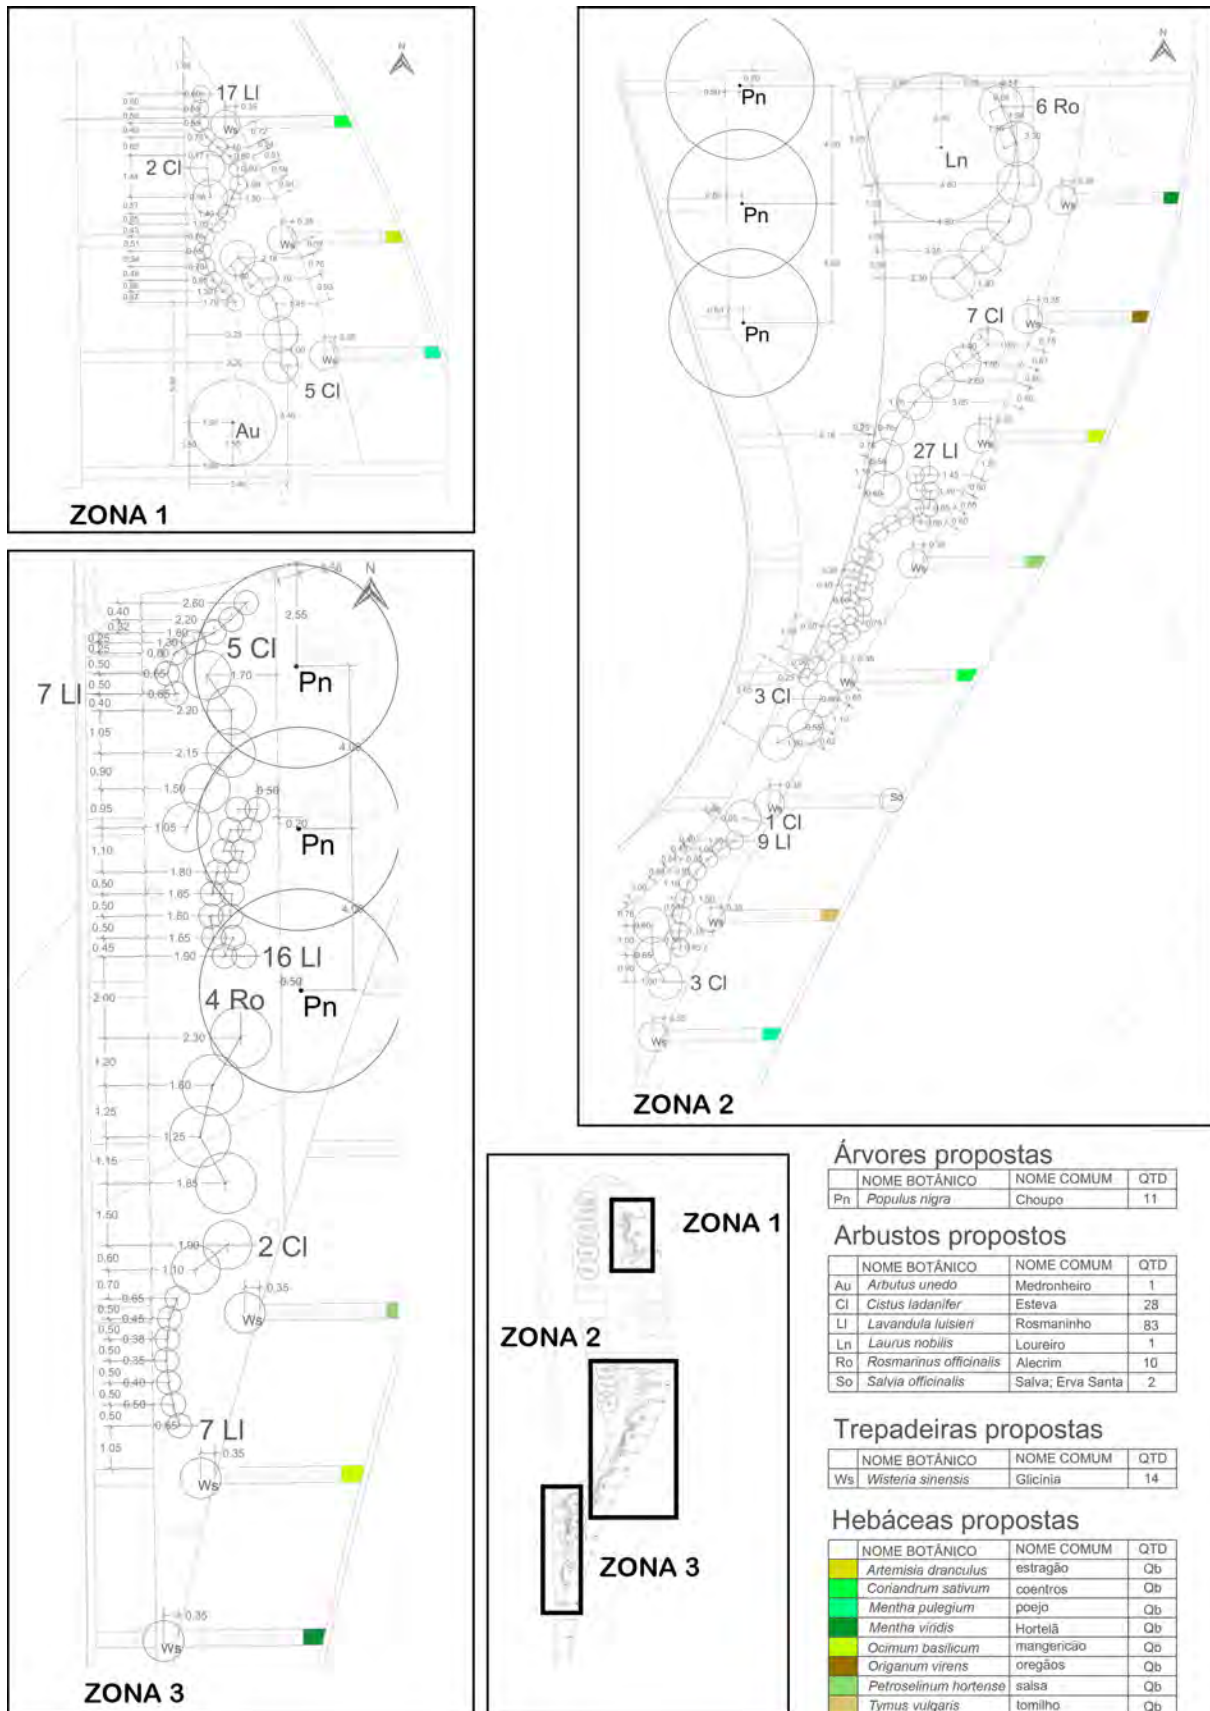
Plano de plantação. S/ escala. Fonte Autor
